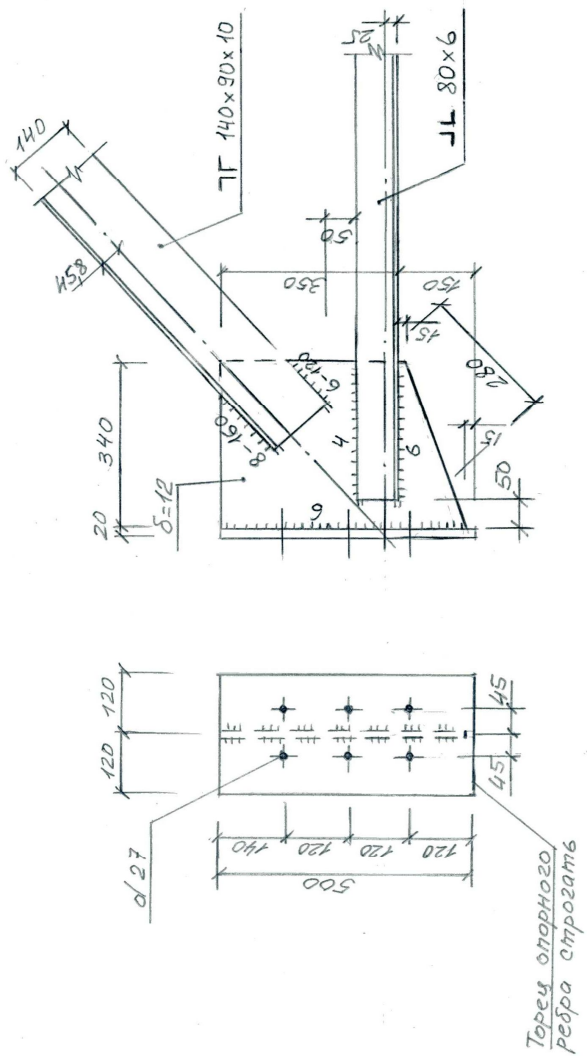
Конструктивне креслення опорного вузла ферми
